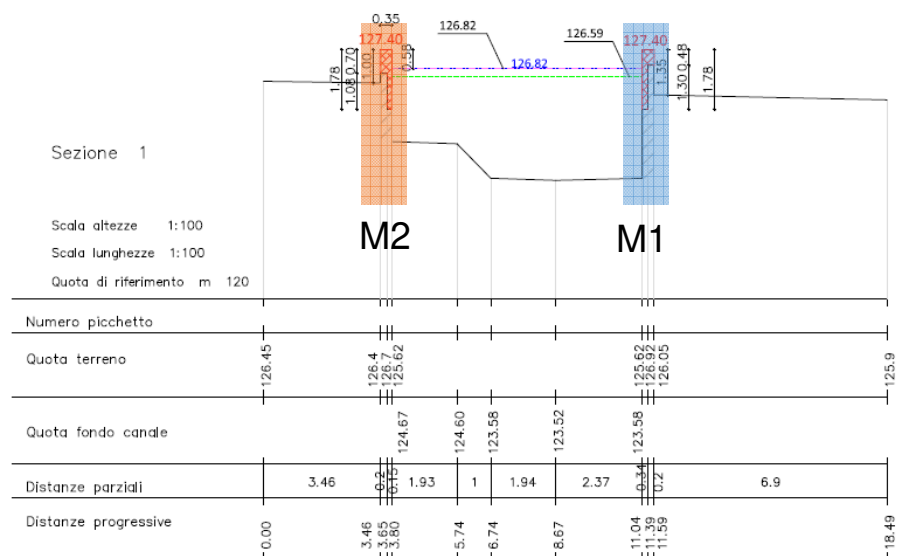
Sezione 1 di sovrapposizione (SITO 2):muro spondale M1 (azzurro), muro spondale M2 (arancio).
